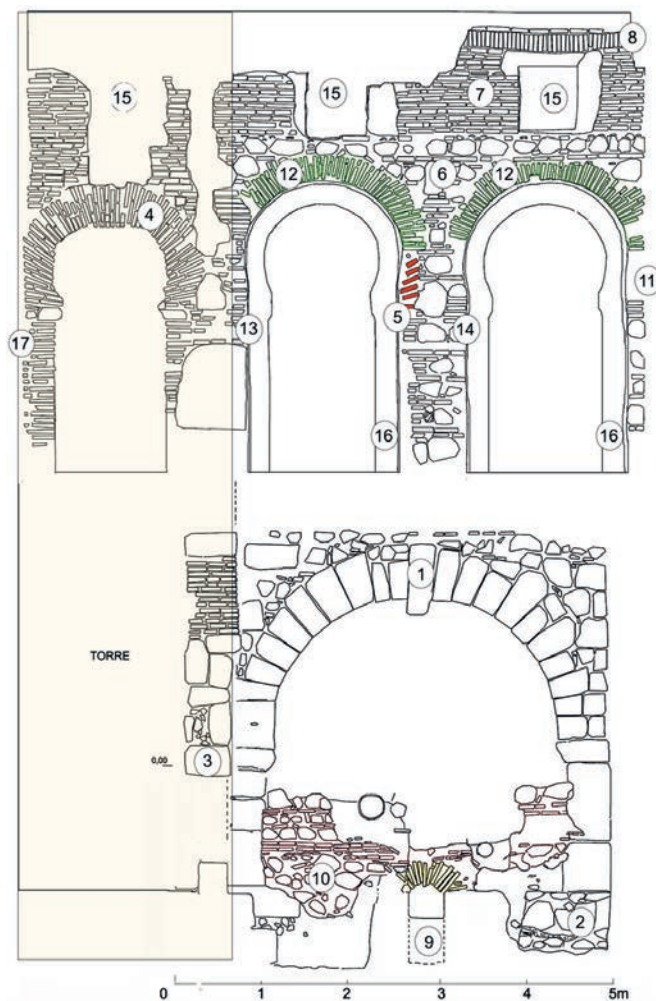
FACHADA OESTE DEL CONJUNTO DE TORNERÍAS (EDIFICIOS A Y B), SUBSUELO Y PLANTAS BAJA Y PRIMERA
